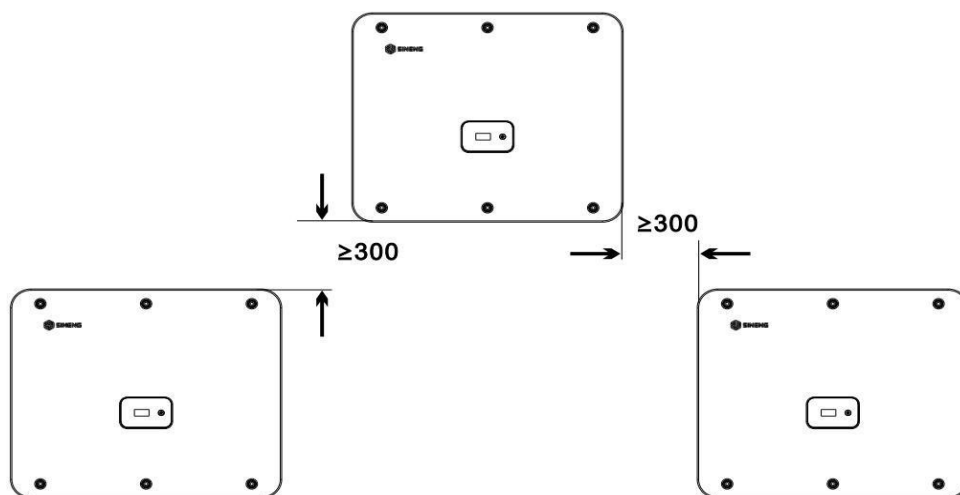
Schema della modalità di installazione sfalsata su più file (unità: mm)
